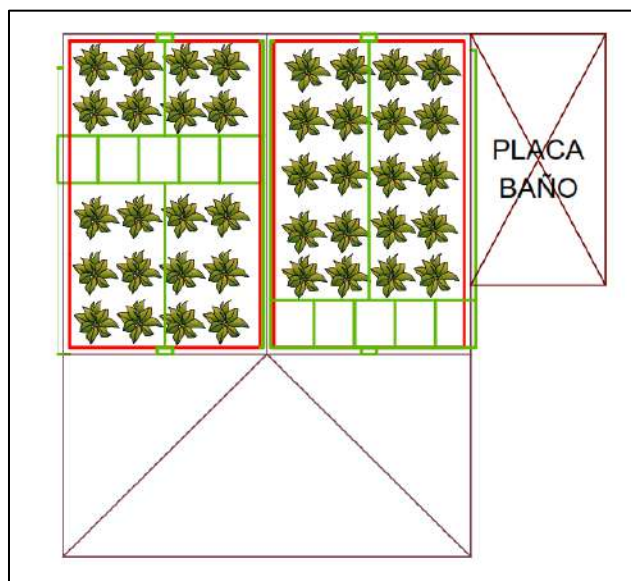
Plano en planta de cubierta existente y futura cubierta verde de 32.75 m²
